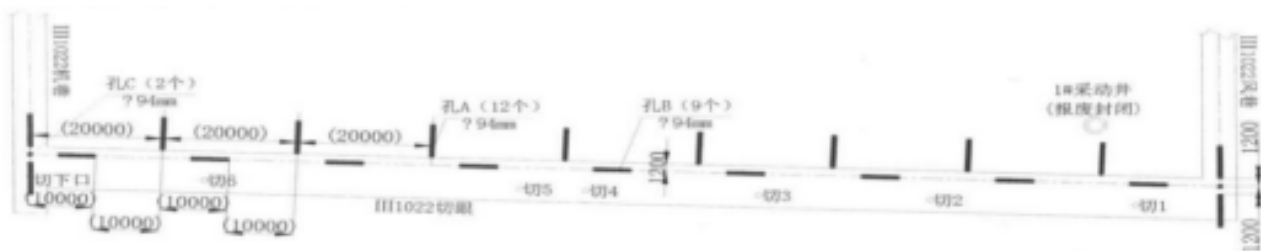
III 1022 切眼切顶水利压裂孔布置平面图
